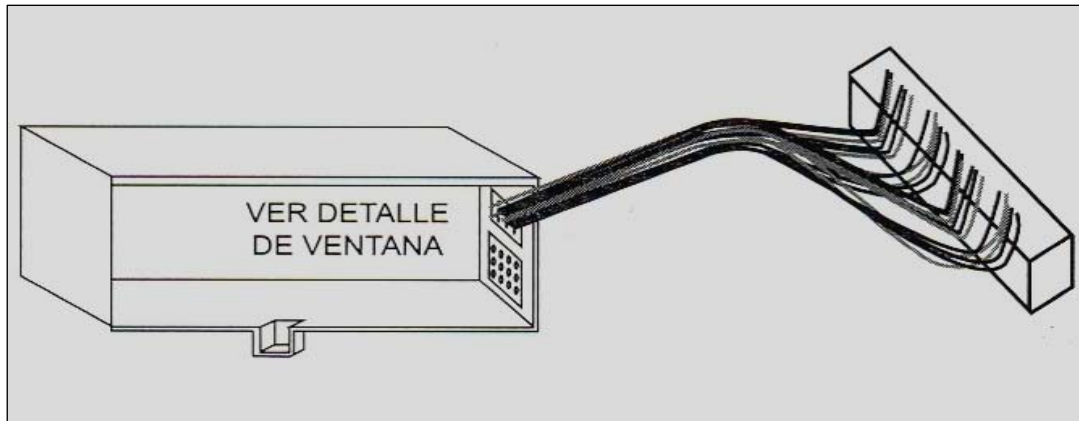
Detalle de Conexión de Pozos Tipo “L” a C.D. Doble.
